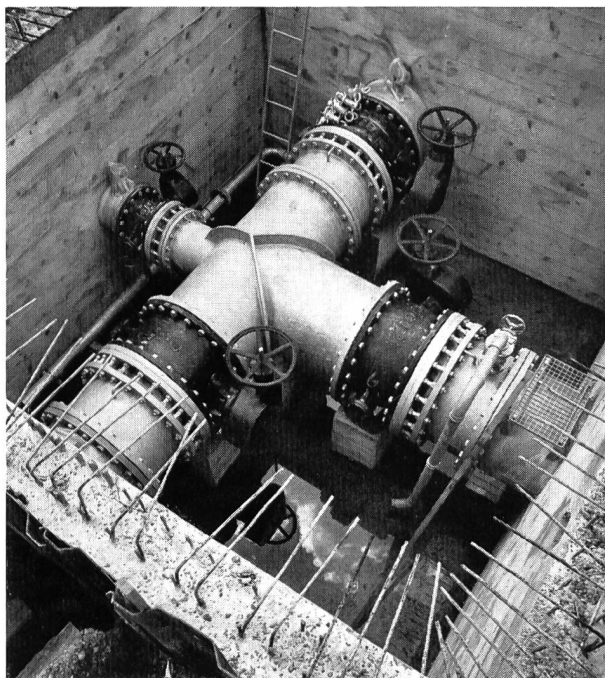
Rohrleitungsbau; Klappenschacht an der Transportleitung Grundwasserwerk Hardhof — Reservoir Lyren.
